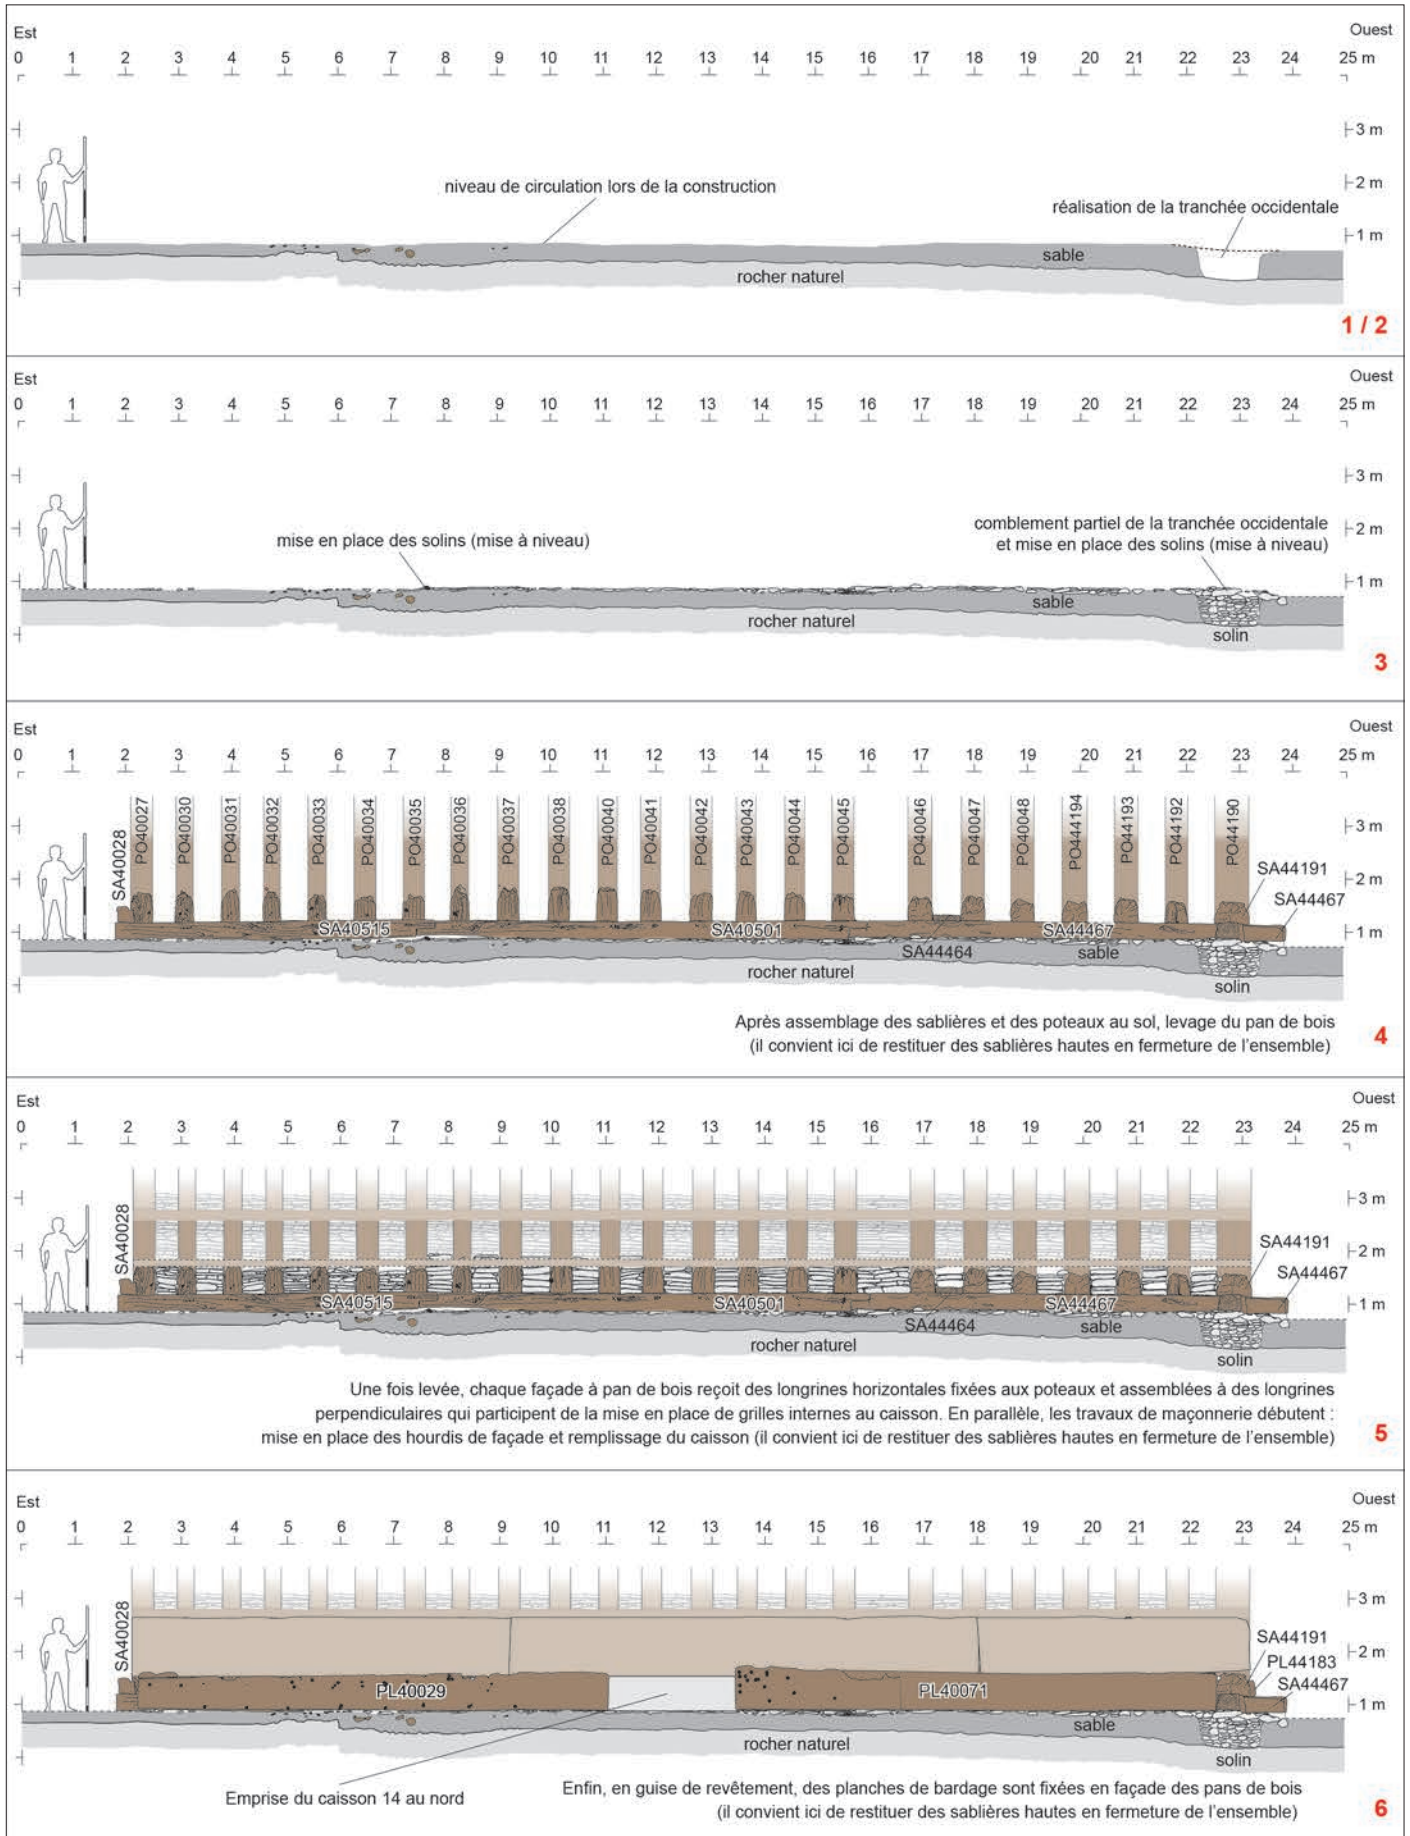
Hypothèse de restitution des étapes de la construction de la façade septentrionale du caisson n° 9 (DAO: J. Mouchard).
